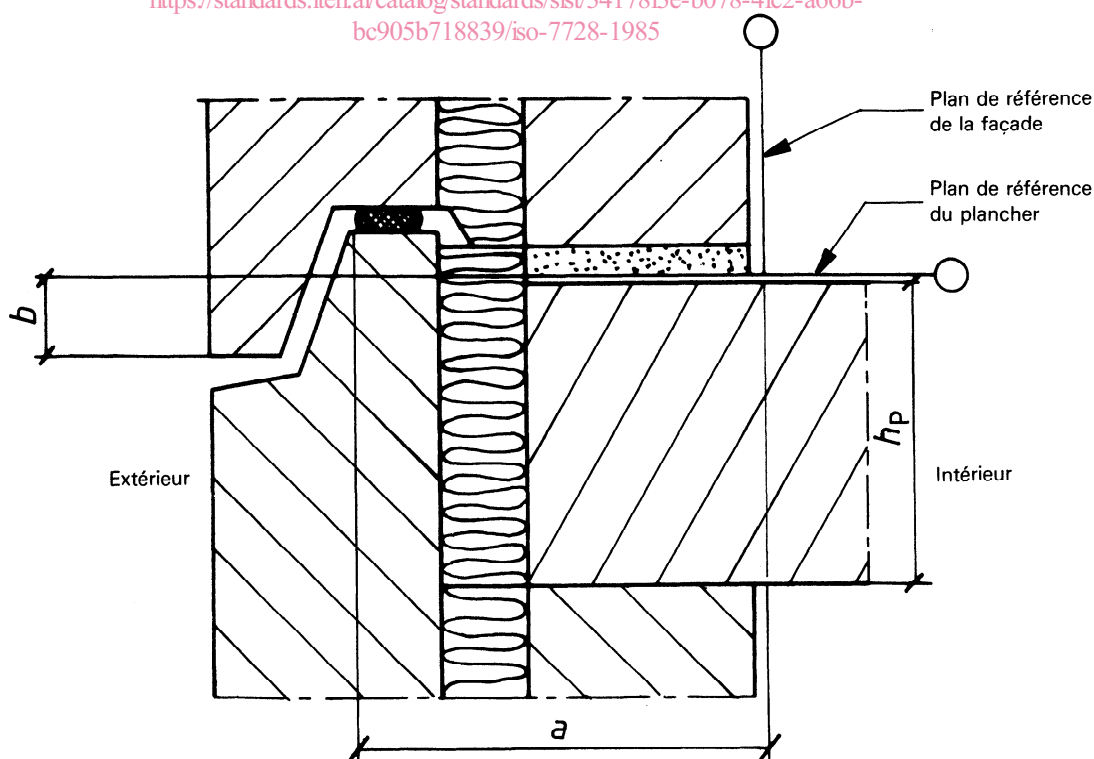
Coupe transversale d'un assemblage entre façade et plancher
